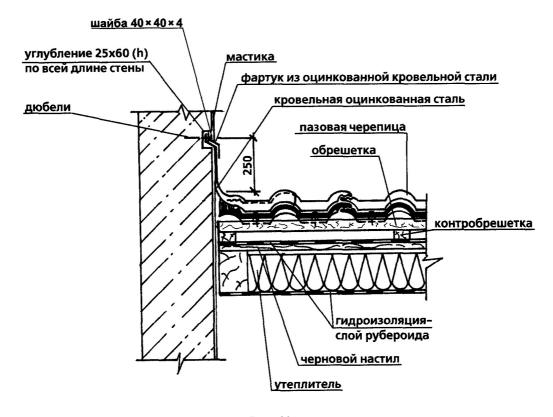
Примыкание к стене фронтона с гидроизоляцией из рубероида
